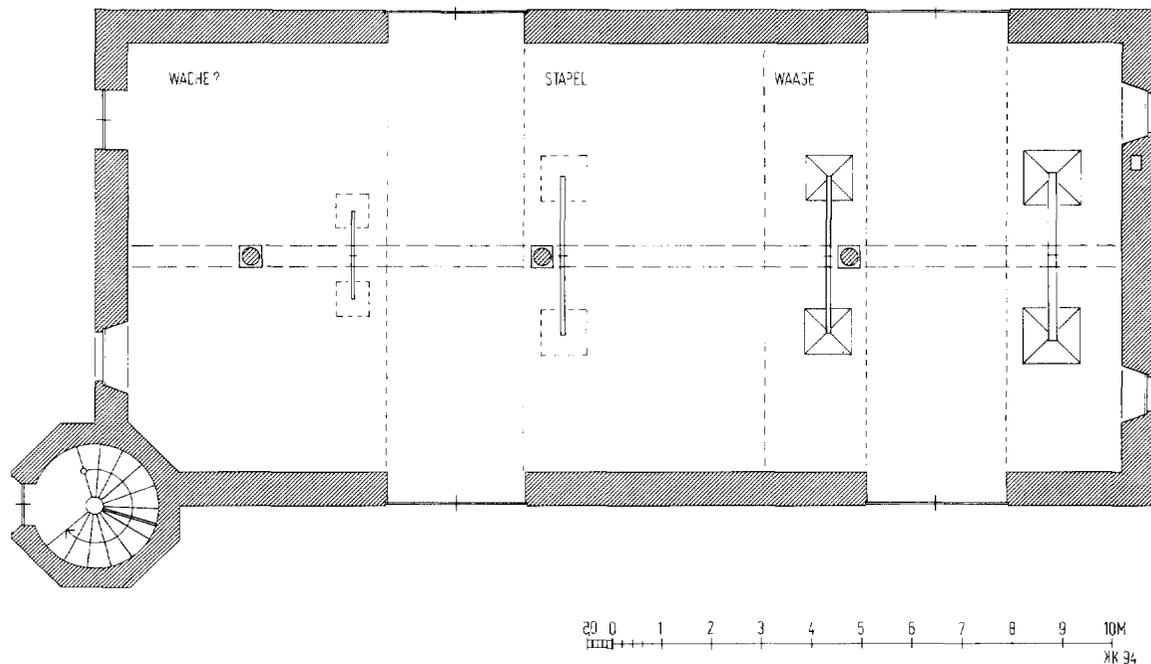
Rekonstruktionsversuch Grundriß. Zeichnung Verfasser.
